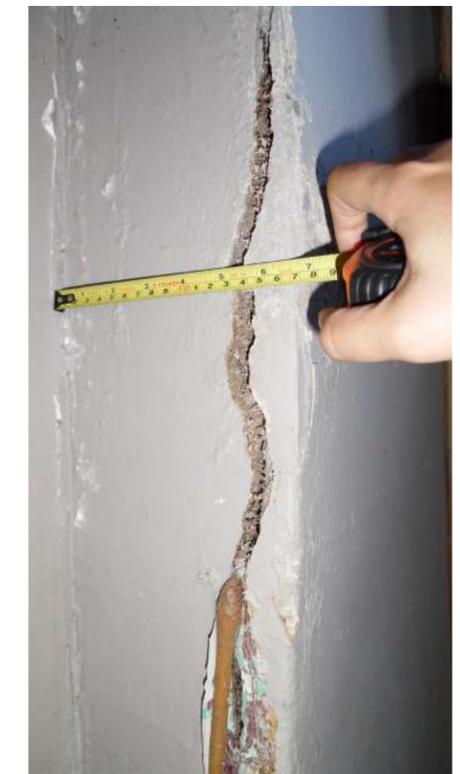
Grieta en columna de 1cm de ancho. (148)
